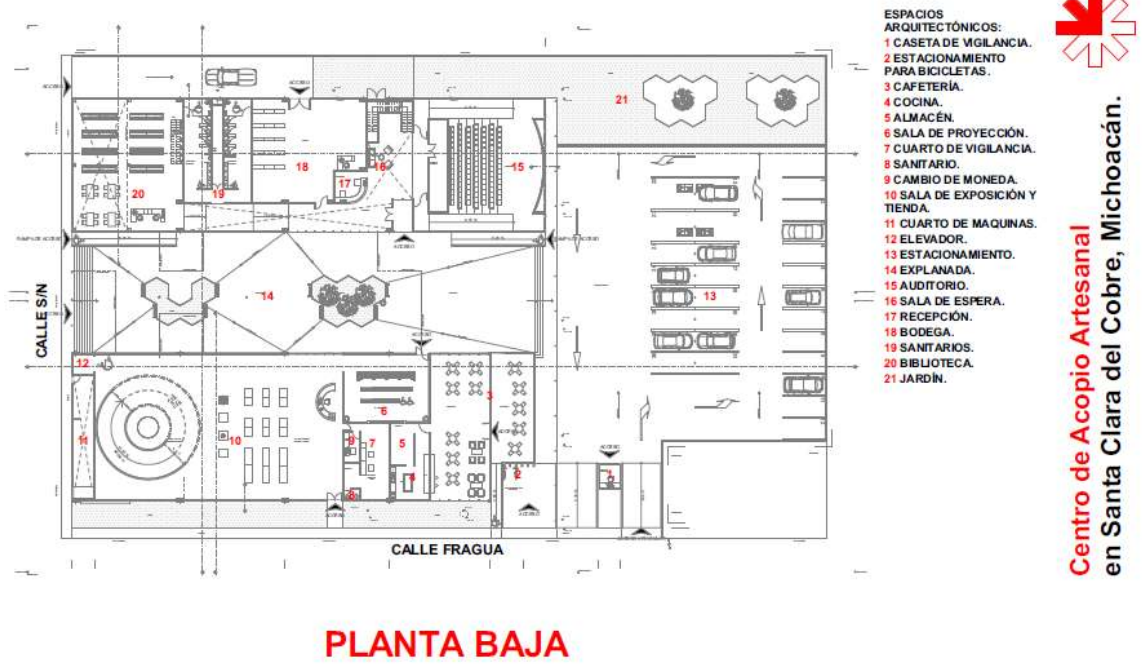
Planta baja del Centro de Acopio Artesanal. Elaboración: del autor. Fecha: 02/02/2017.
